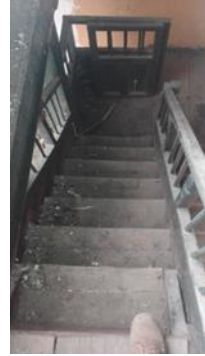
Segundo tramo escalera en madera que conduce a segundo piso termina en gran balcón.
